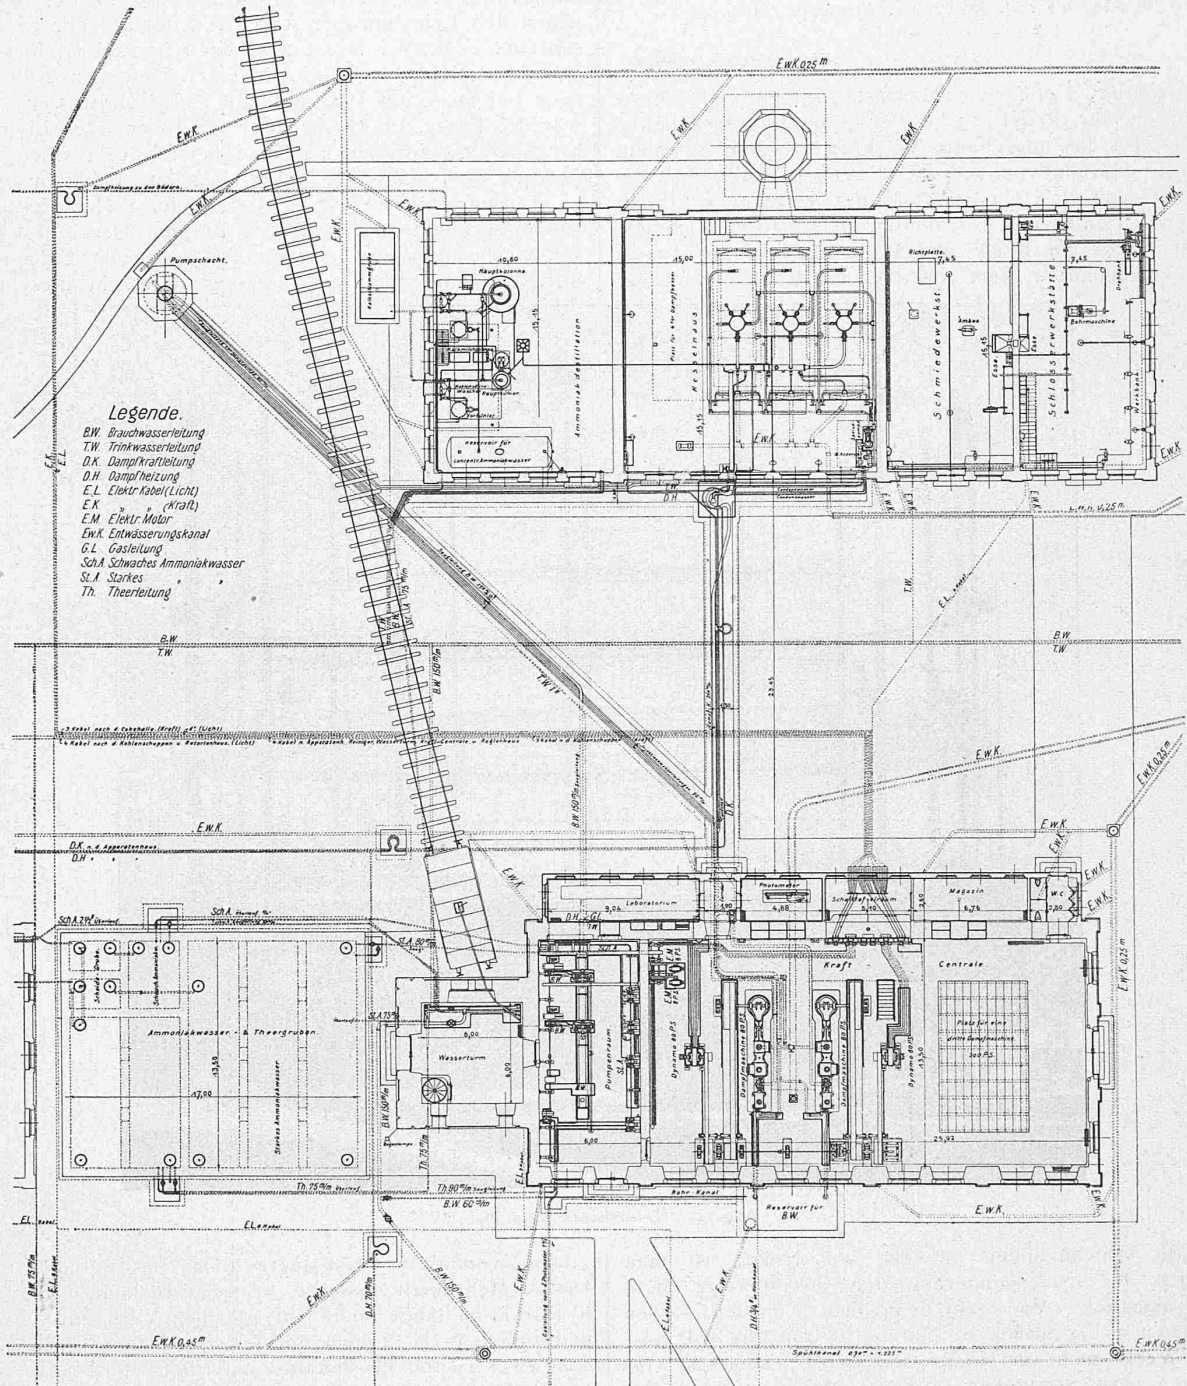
Grundriss vom Dampfkesselhaus, der Krafzentrale, Pumpenanlage, den Teer- und Ammoniakwassergruben.
